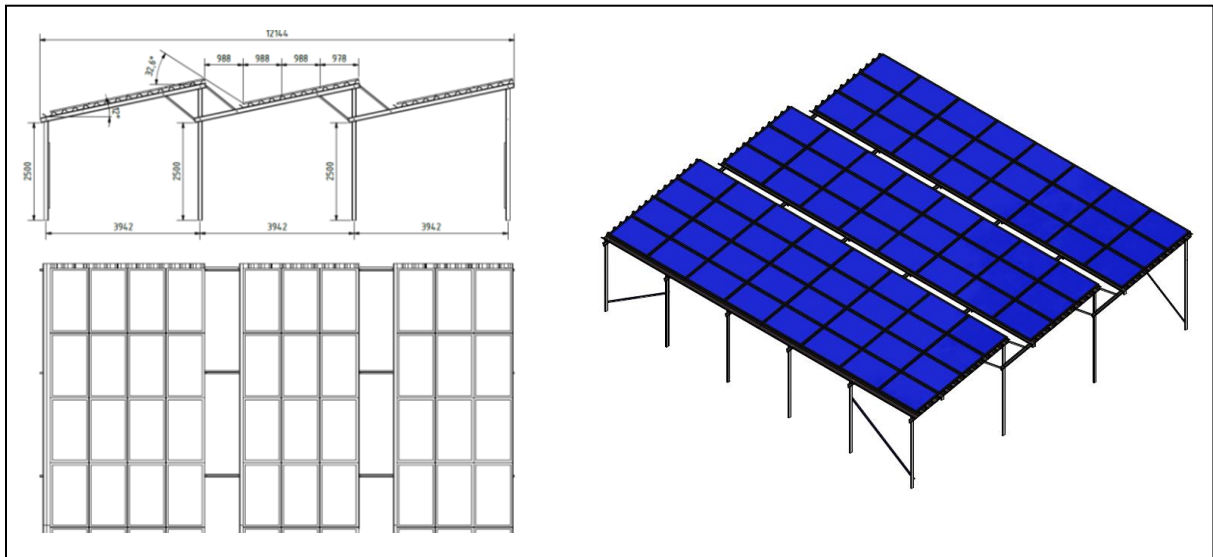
Prinzipskizze Mehrzweckhalle Schrägdach, SOLprime Power Systems GmbH
